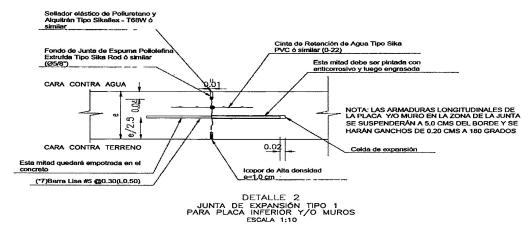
Detalle constructivo para juntas de expansión entre los muros y losa inferior de los box culvert.
